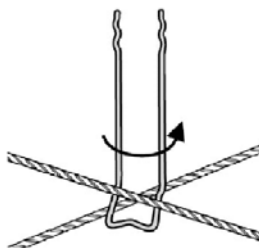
Anstecknadel nach links über unteren Bewehrungsstab drehen.
